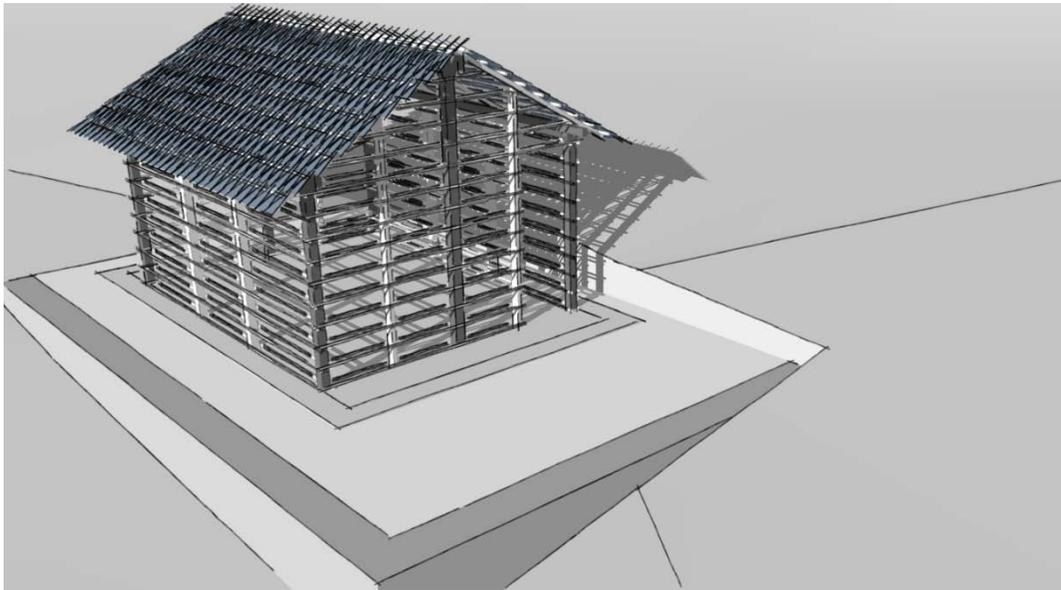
Construcción de las armaduras de las paredes y de los dinteles (partida "Sobreestructura").
